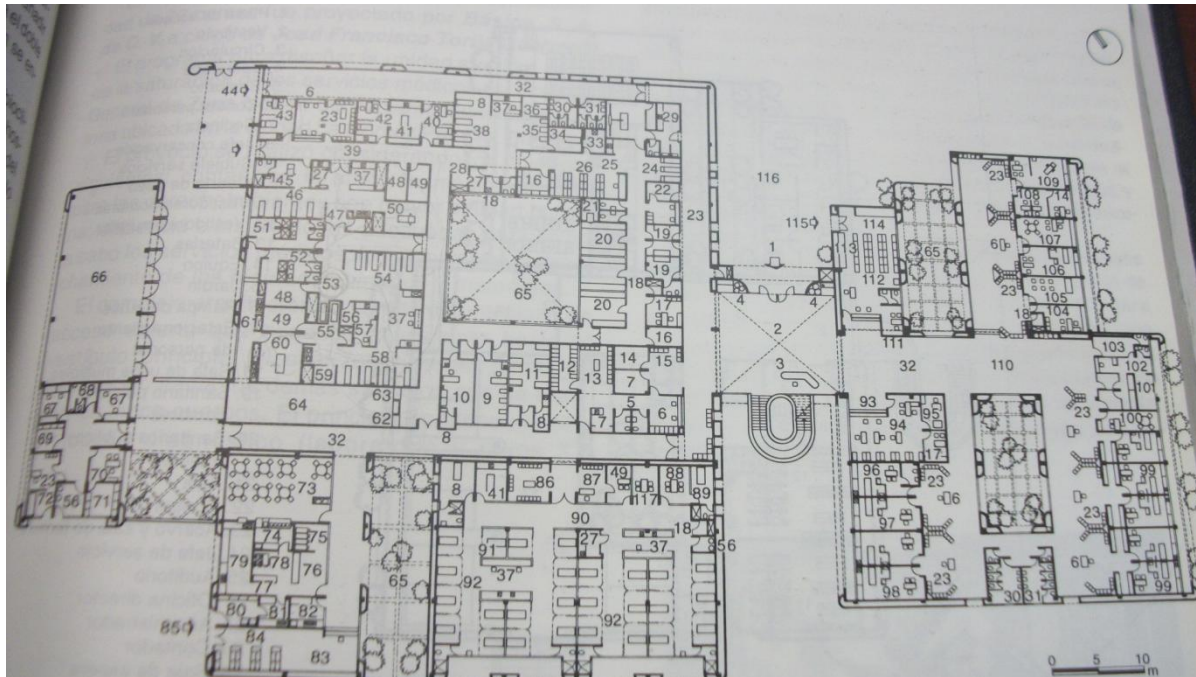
Planta baja general S/E. Fuente: Plazzola tomo IV.
